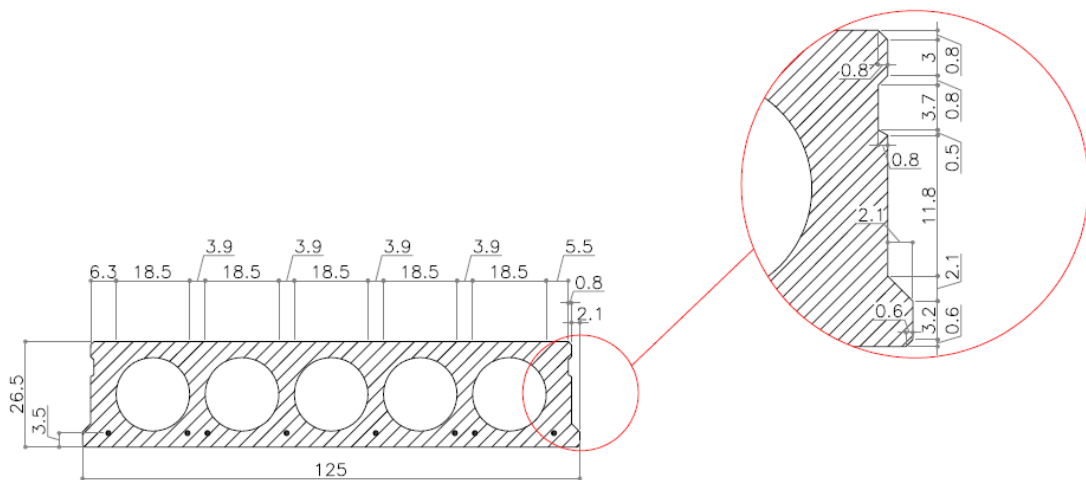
SEÇÃO TRANSVERSAL DAS LAJES ENSAIADAS.
